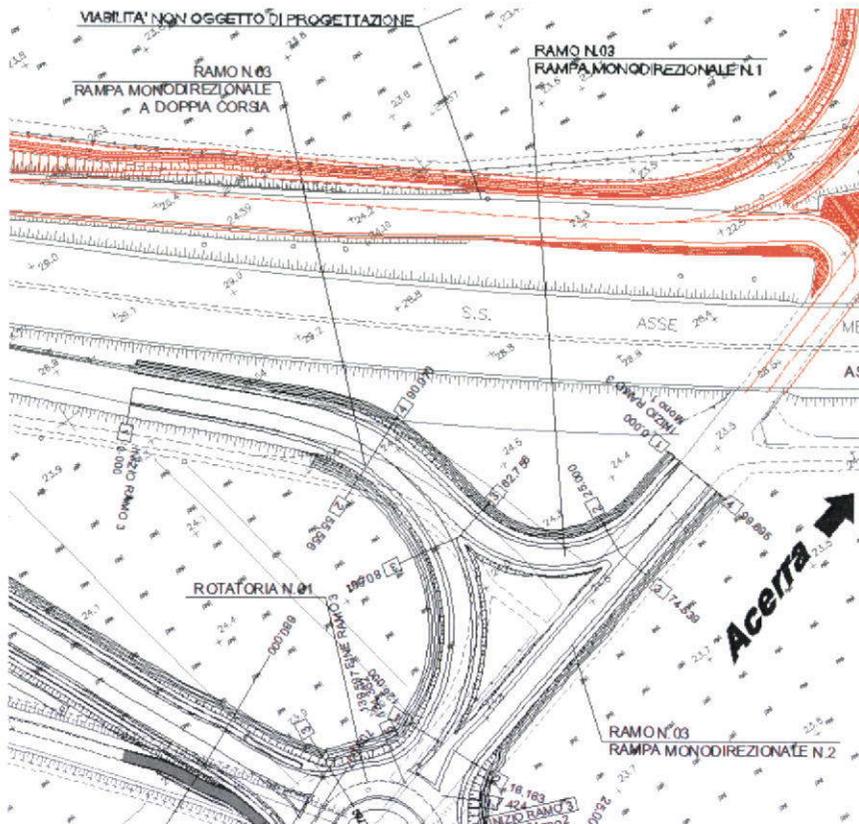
Planimetria di progetto nel tratto interessato dai rami 3
